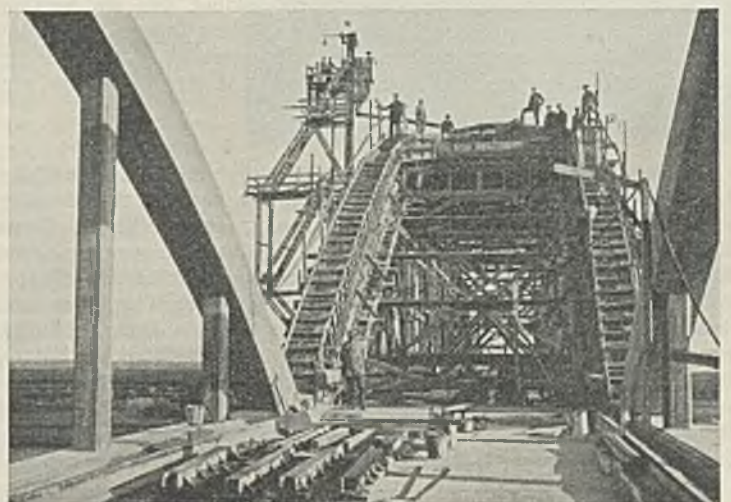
Betonieren des mittleren Bogens mittels der Betongießanlage.
